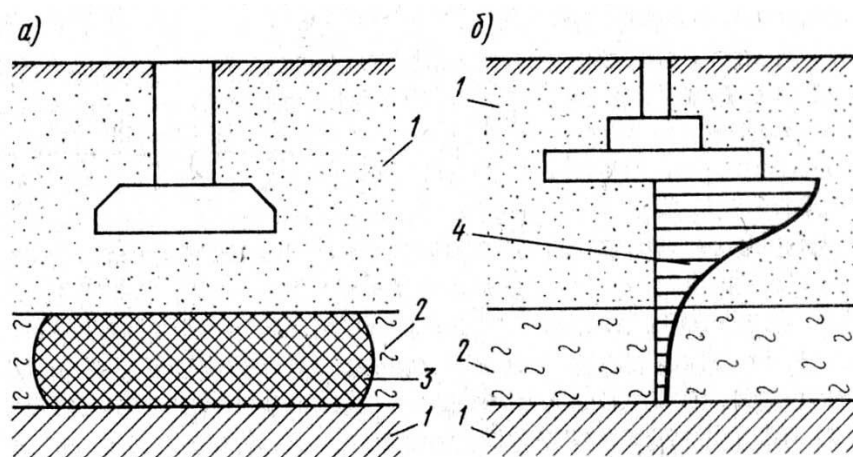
Устройство фундаментов при напластовании грунтов (тип 3):
